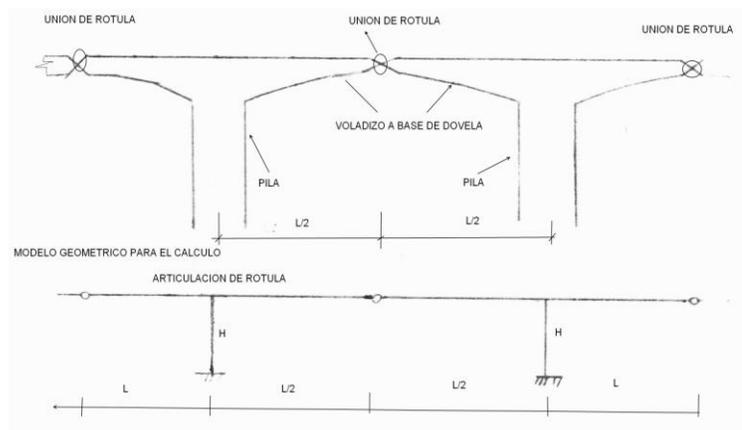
Esquema de articulación central en puentes isostáticos
